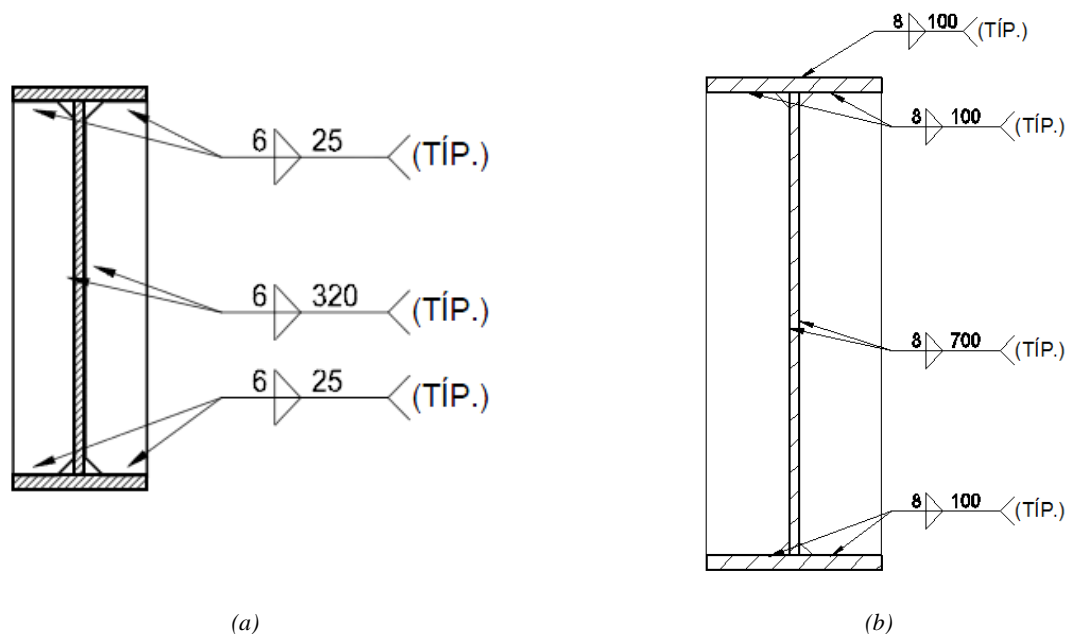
Rigidizador en apoyo para el gato hidráulico - (a) Puente entre unidades; (b) Puente de acceso
